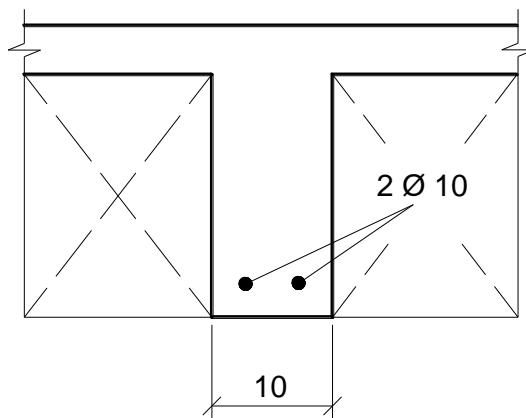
Detalhamento da armadura de flexão na seção transversal da nervura.
